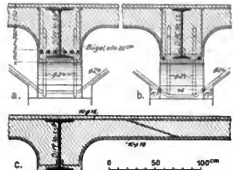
Decke über dem Bühnenraum im Dachgeschoß.
